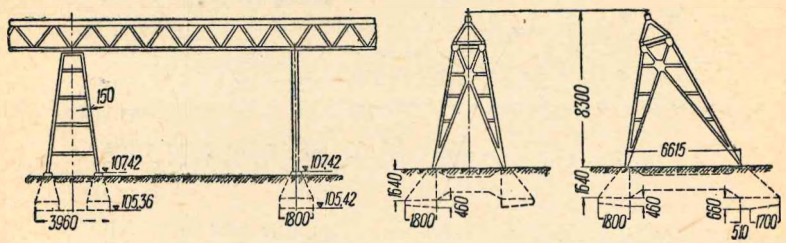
Сборная железобетонная эстакада ЛИИЖТ
